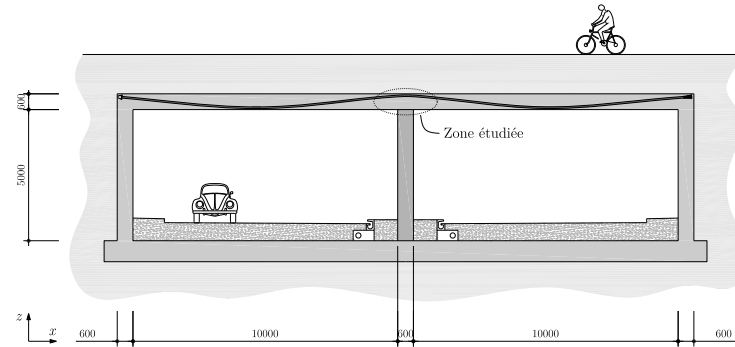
Coupe transversale d'une tranchée couverte - Dalle supérieure appuyée en son centre sur une rangée de colonnes - Données en [mm]
